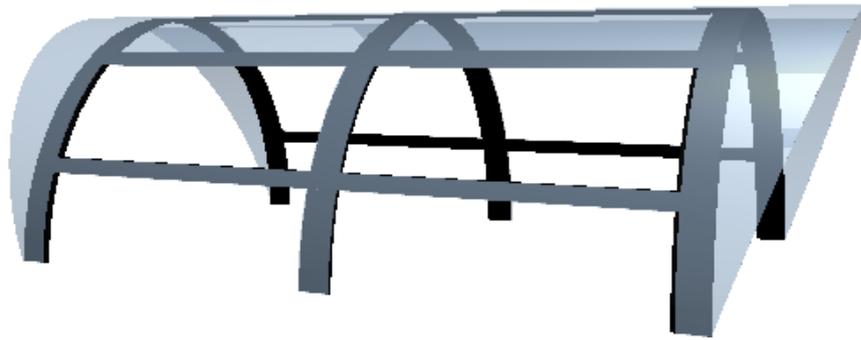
Grelha em concreto armado pré-moldado (em preto na figura) sob cobertura de telhas metálicas termoacústicas (que aparecem translúcidas na figura para melhor compreensão).
